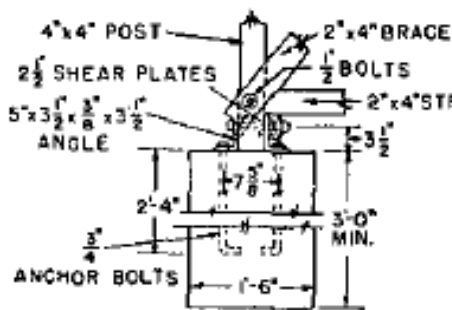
Věž pro zaměřovač – details platformy a můstku pro spojení s protiletadlovou věží
